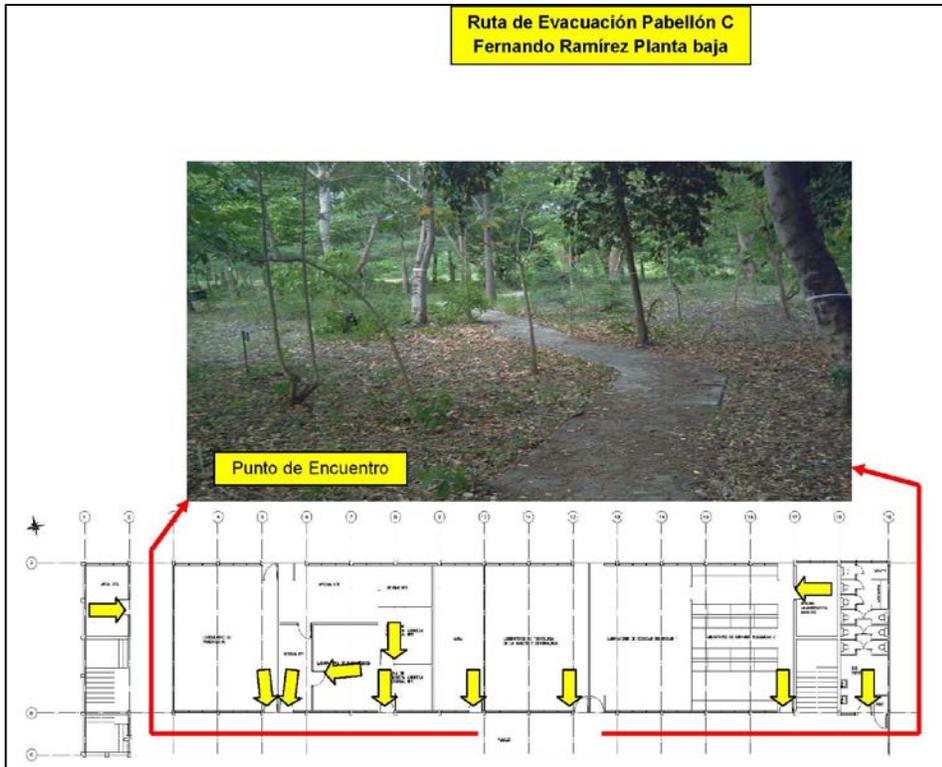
Ruta de evacuación del pabellón “C” (planta baja)
